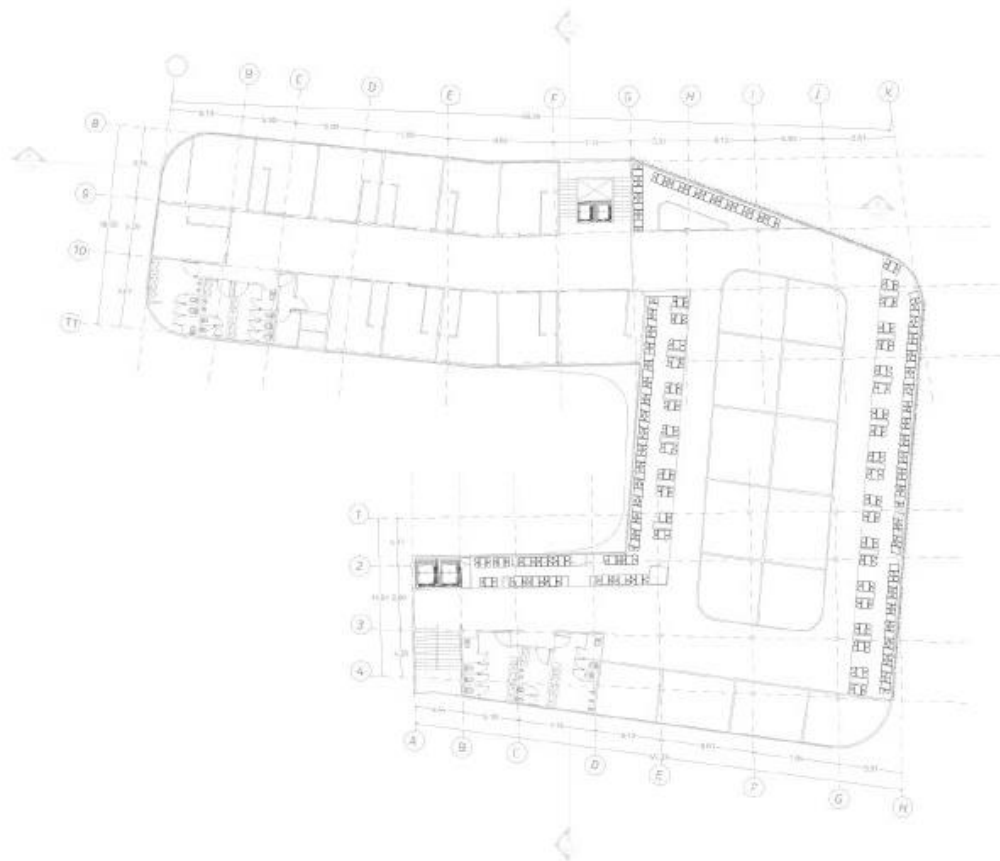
Planta tercer piso.Fuente: Elaboración propia.
